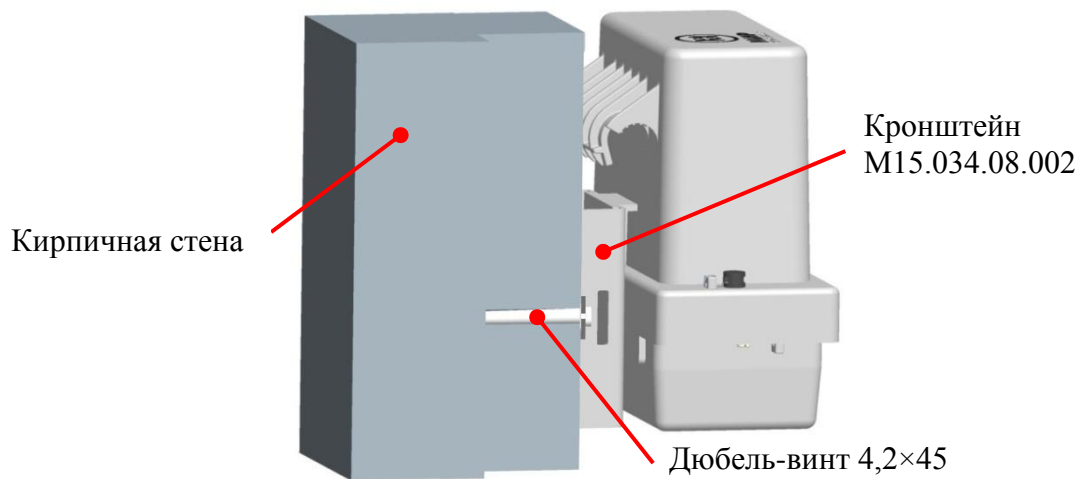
Установка устройства M22.003.00.000-02
